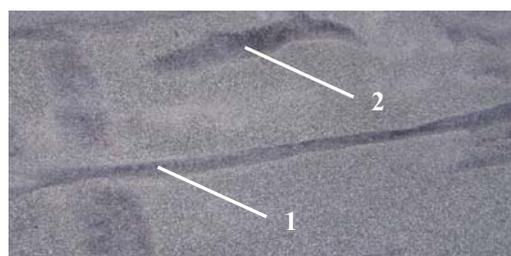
Состояние верхнего слоя водоизоляционного рулонного ковра: 1 – верхний слой водоизоляционного рулонного ковра с разрушенной защитной заводской посыпкой; 2 – складки в верхнем слое водоизоляционного рулонного ковра
